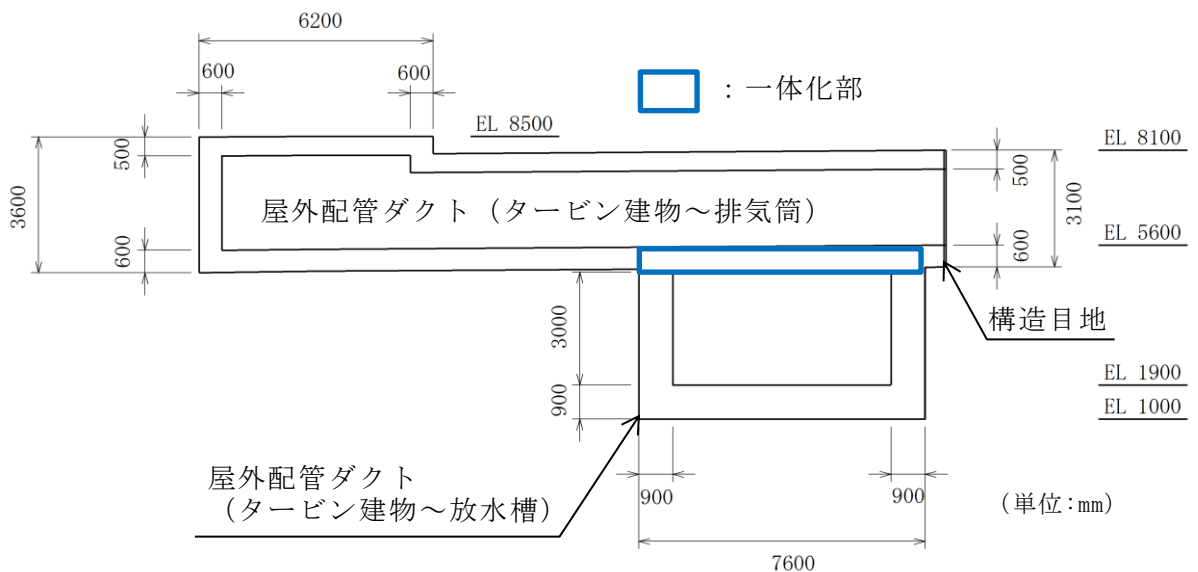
(3) 屋外配管ダクト (タービン建物～排気筒) 断面図 (C-C 断面)
